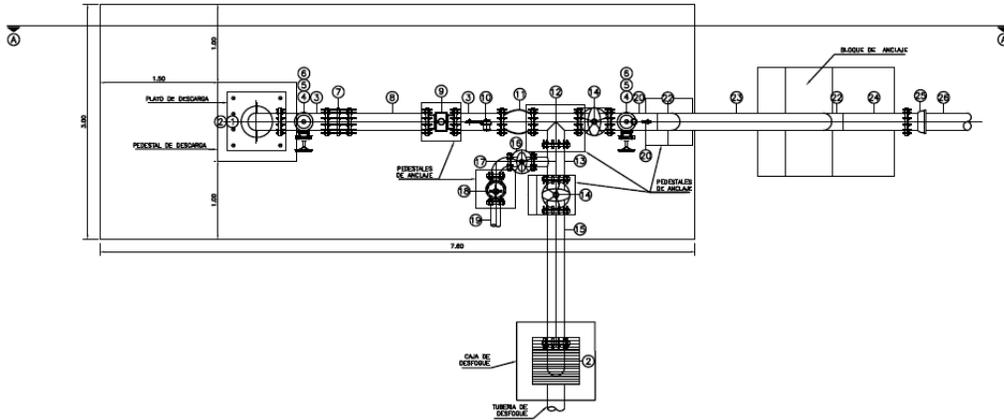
Vista de Planta Para diseño Propuesto. Sin Escala. Fuente: Mesen, 2019, AutoCad
